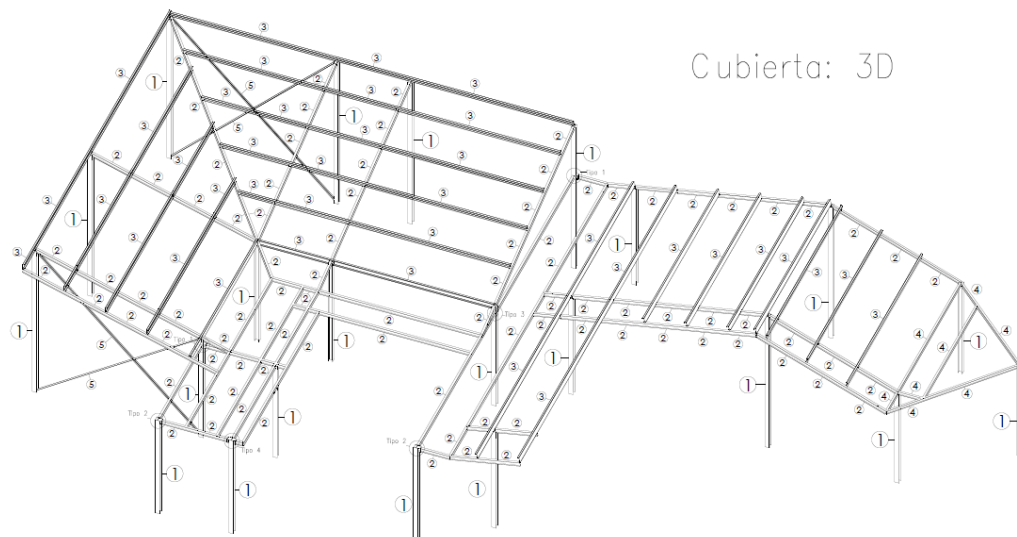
Plano Cubierta en 3D. Colegio. CAJAMAG.
